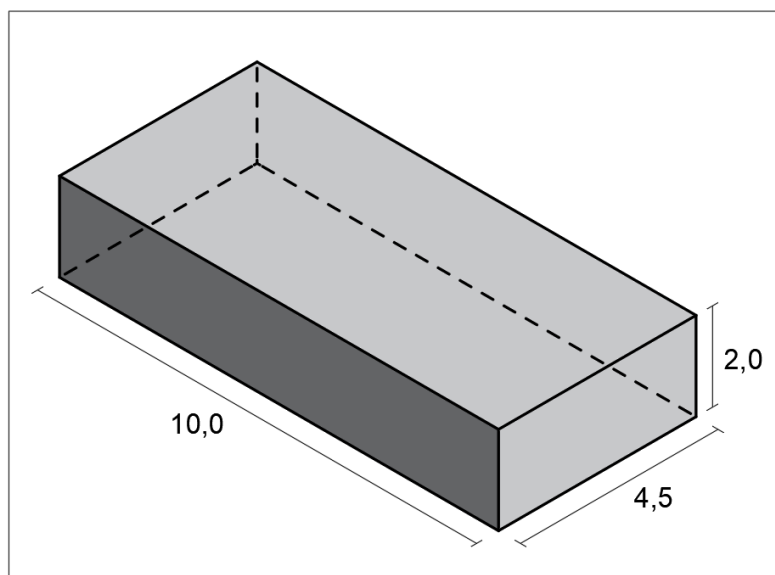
Dimensões da estrutura do píer flutuante de concreto em metros.
